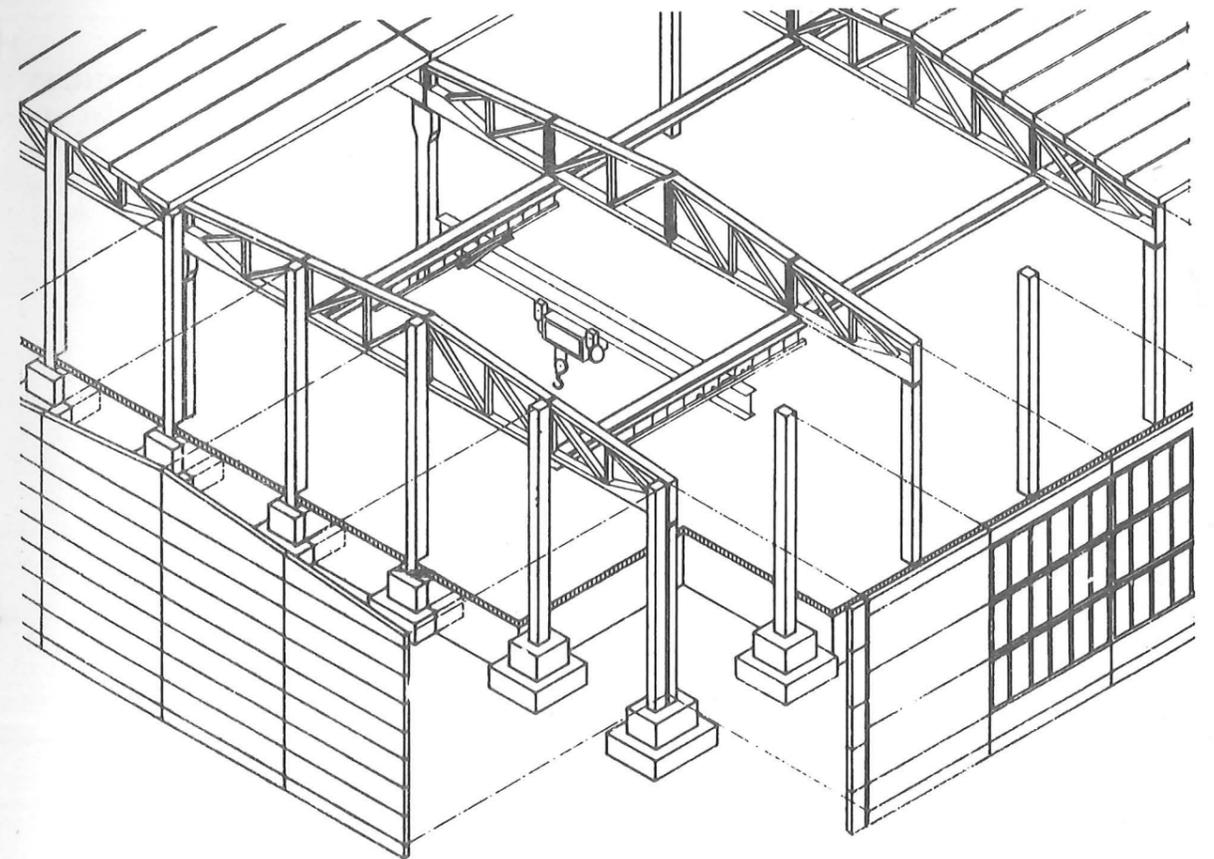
Isometrische Darstellung einer mehrschiffigen Halle mit Satteldach-Fachwerkbindern - Achsabstand 12000 mm mit Hängetransport mit großflächigen Außenwandplatten
